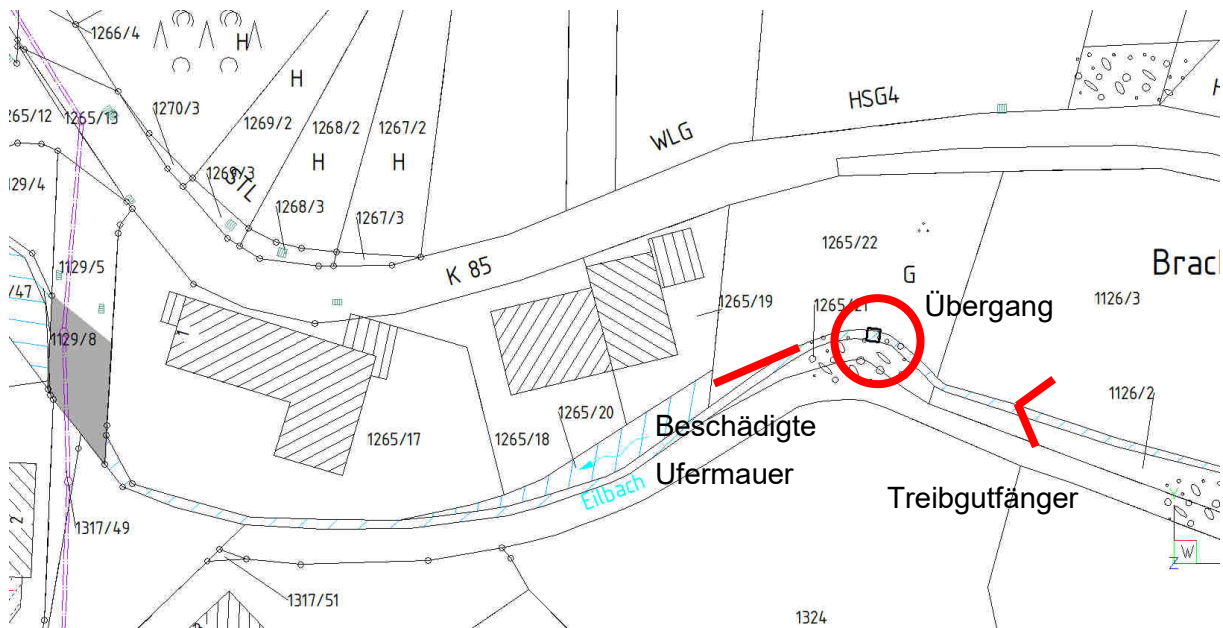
Lageplanausschnitt Eilbach Bereich Ortslage
